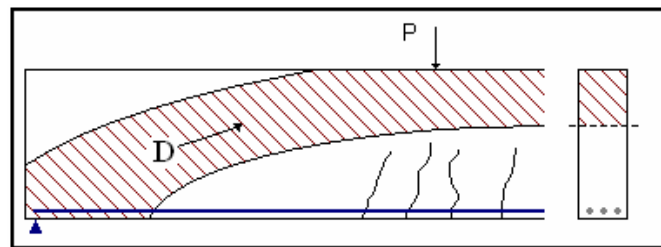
Comportamento estrutural de vigas de seção retangular (LEONHARDT & MÖNNING, 1977)
